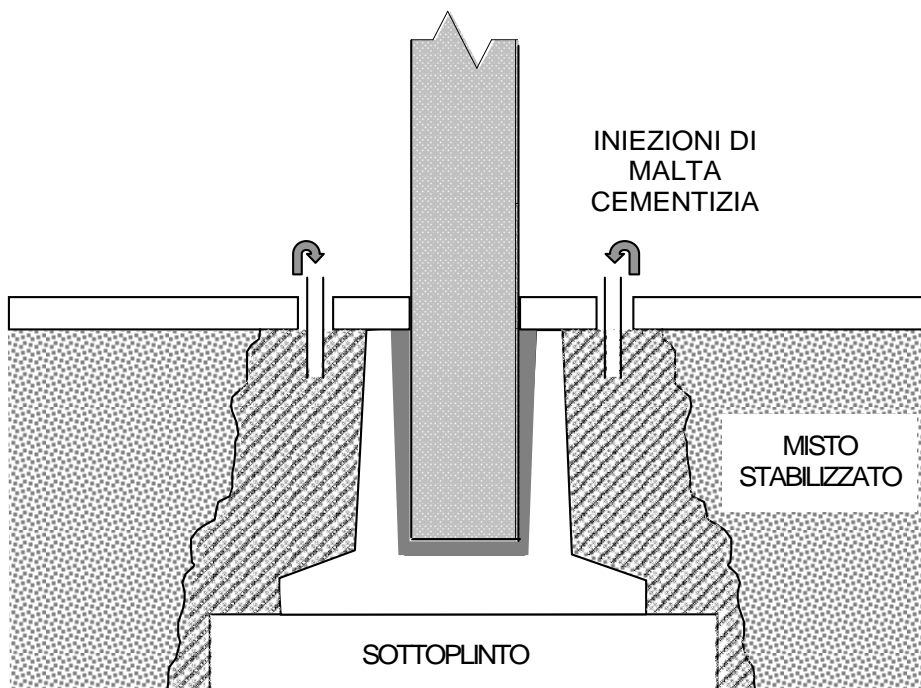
Intervento locale di consolidamento con iniezioni a bassa pressione di malta cementizia
